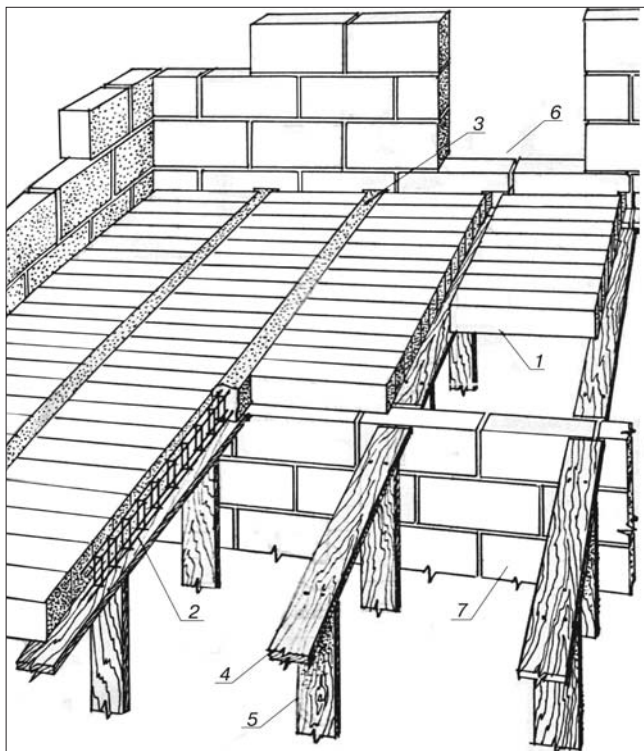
Сборно-монокрипное перекрытие из мелких газобетонных блоков: 1 – мелкие газобетонные блоки; 2 – арматурный каркас с рабочей арматурой; 3 – монокрипный шов из раствора класса В 10–15; 4 – доска опалубки; 5 – стойка под опалубку; 6 – дверной проем на балкон; 7 – внутренняя стена
